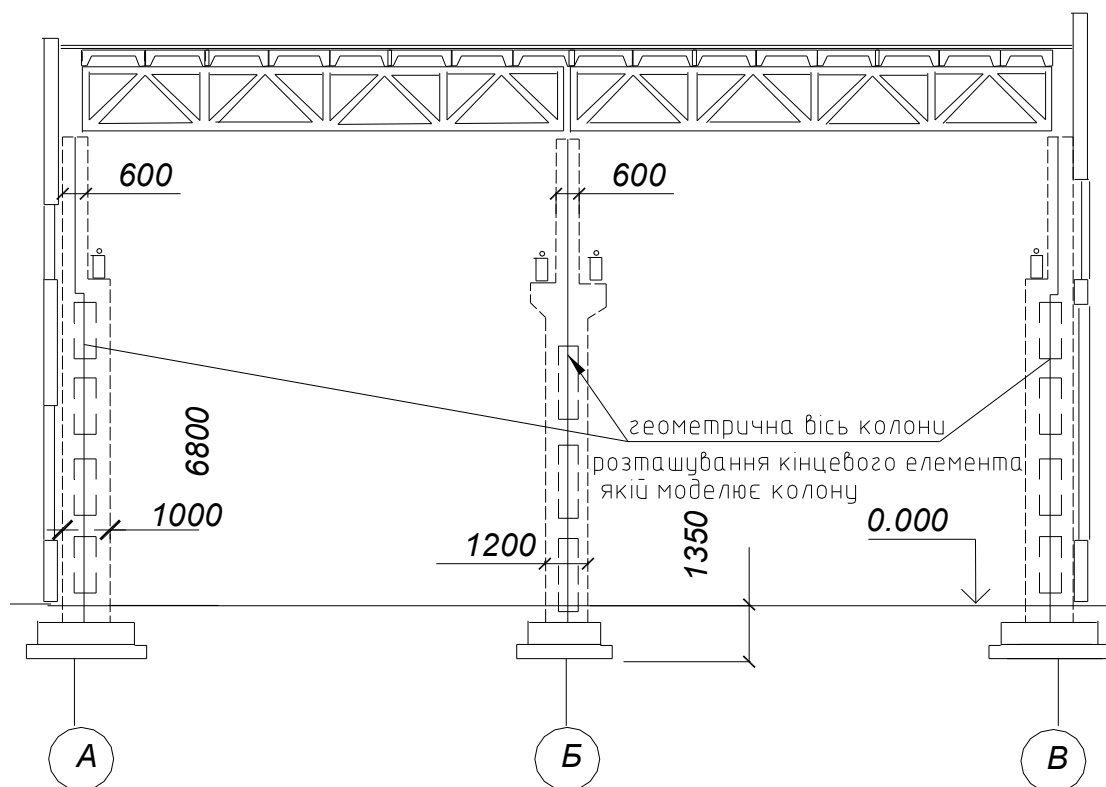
Поперечна рама будівлі з двогілковими колонами
